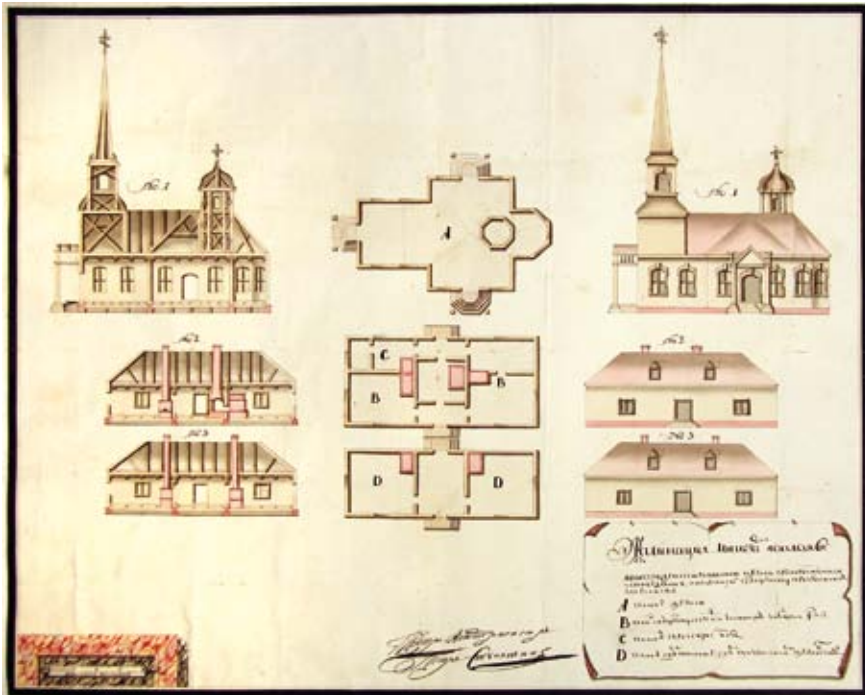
Kuressaare. Grundrisse, Schnitte und Aufrisse von einer hölzernen russisch-orthodoxen Kirche und zwei Gesindehäusern in Arensburg (1748). RGADA, fond 248, opis' 160, delo 1796.
